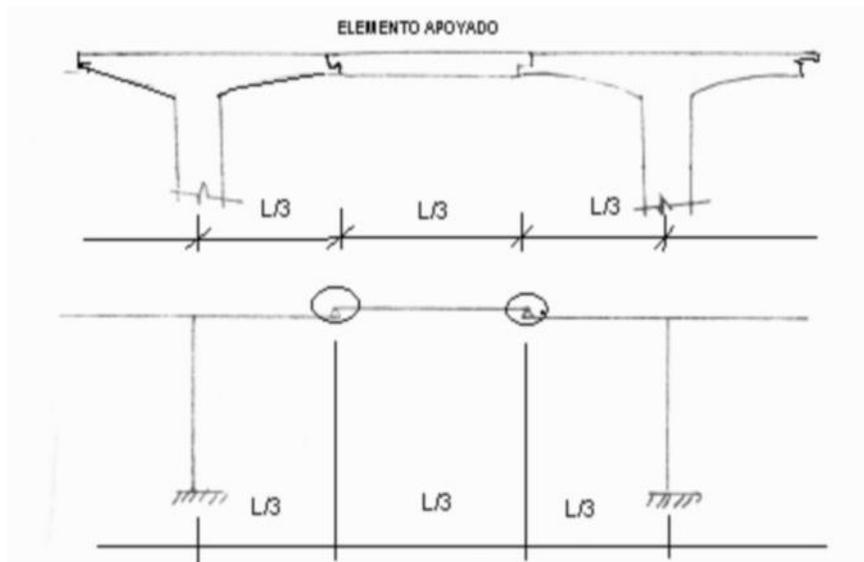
Esquema de elementos tipo gerber en puentes Isostáticos
